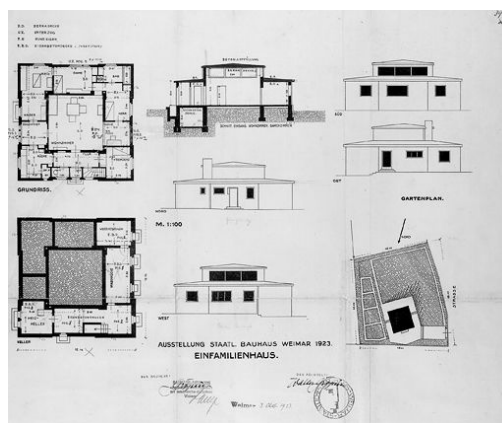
Plantas e alçados da casa A Haus am Horn MUCHE (1923)
